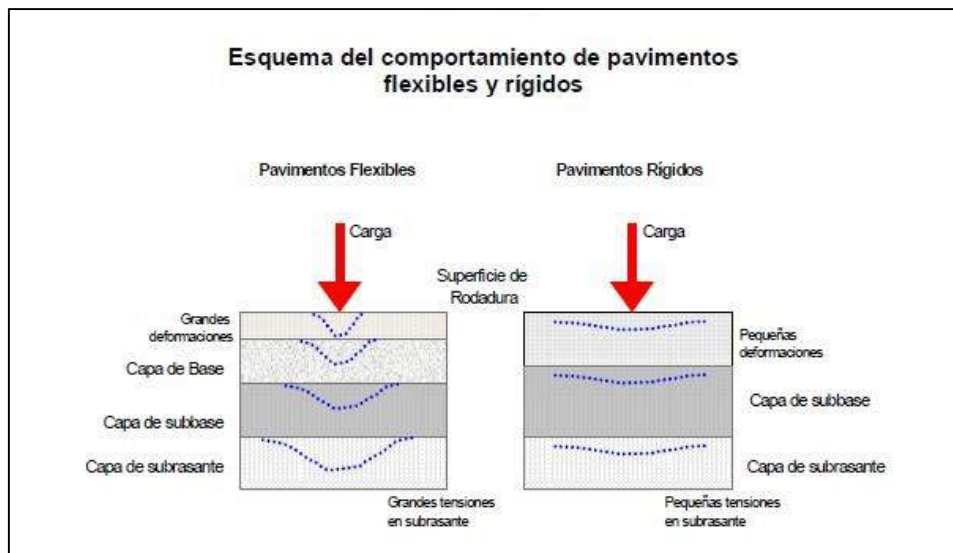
Comportamiento de los pavimentos flexibles y rígidos
